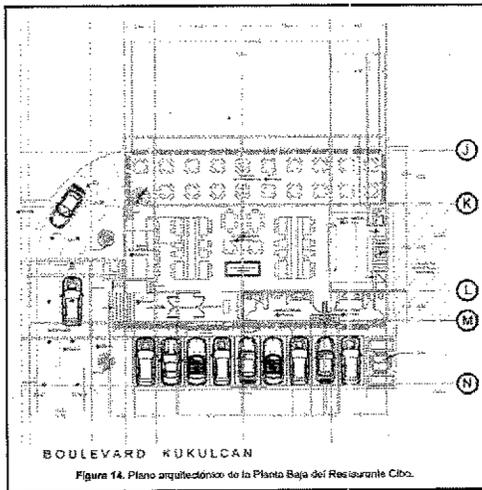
Plano arquitectónico de la Planta Baja del Restaurante Cibo.
